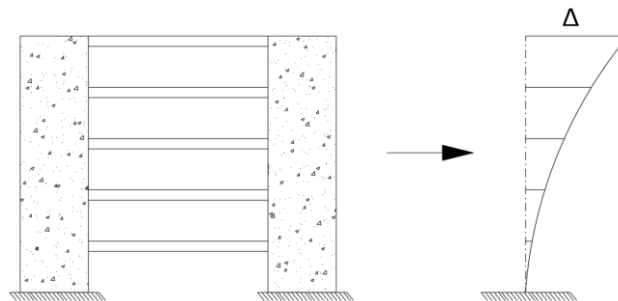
Perfil de desplazamiento para muros en cantiléver.
